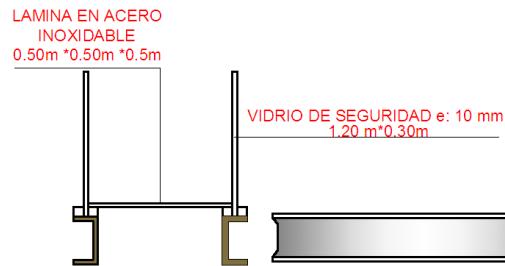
Vista zona de descargas en perfil sin doblez y planta con doblez.
